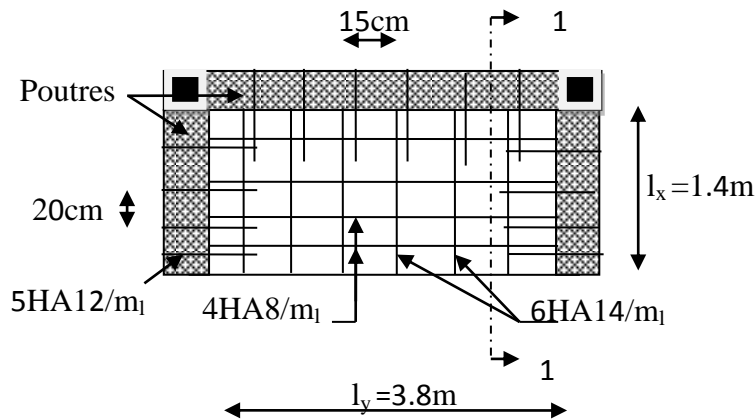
Schéma de ferrailage du panneau de dalle D3
